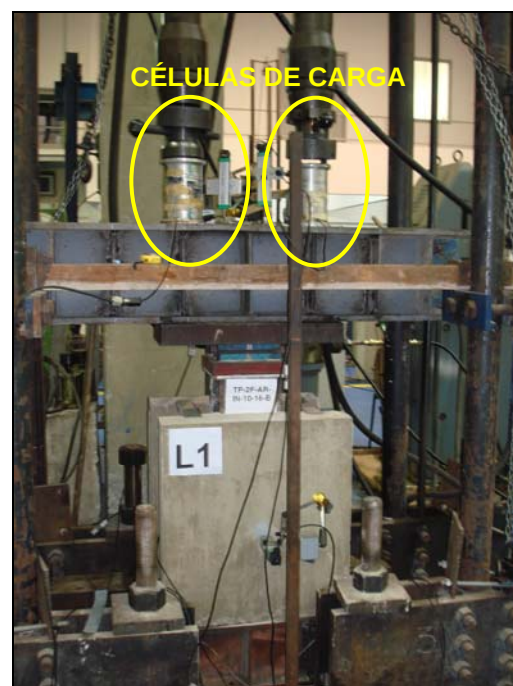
Estrutura de reação e instrumentação para o ensaio tipo *push-out*, LEM.
